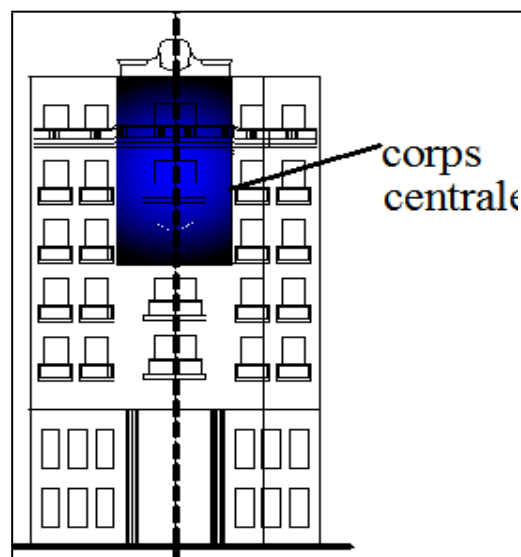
La présence d'un corps centrale dans la façade de BNCI
